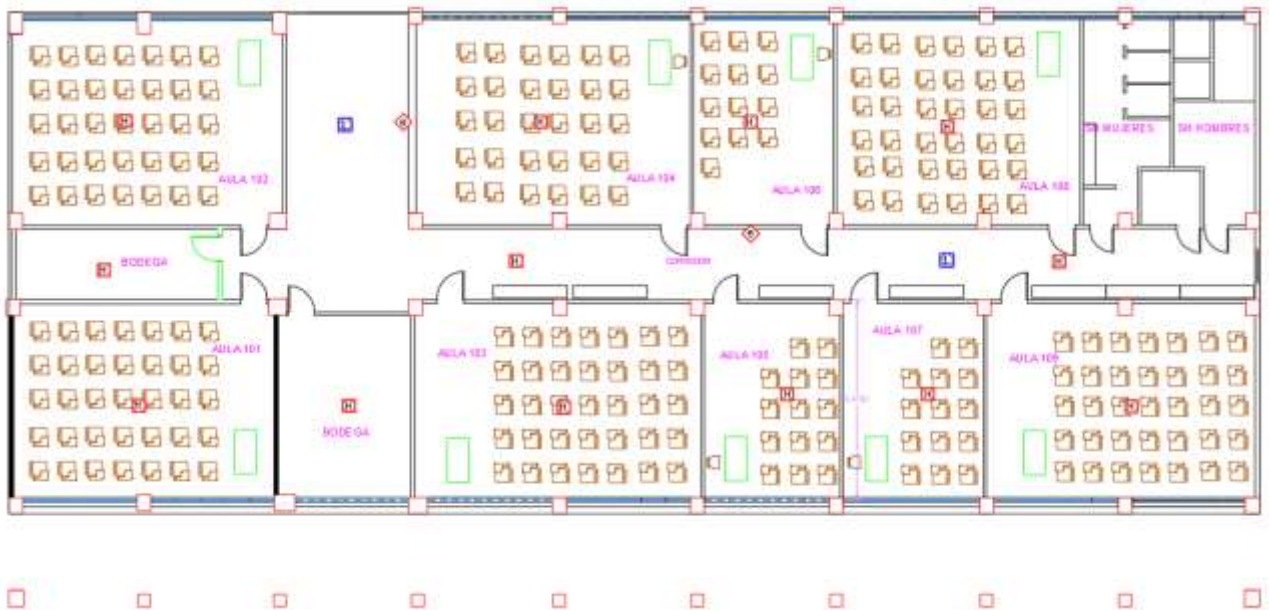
Primer piso - Plano Arquitectónico. Fuente: (Coordinación Académica)
